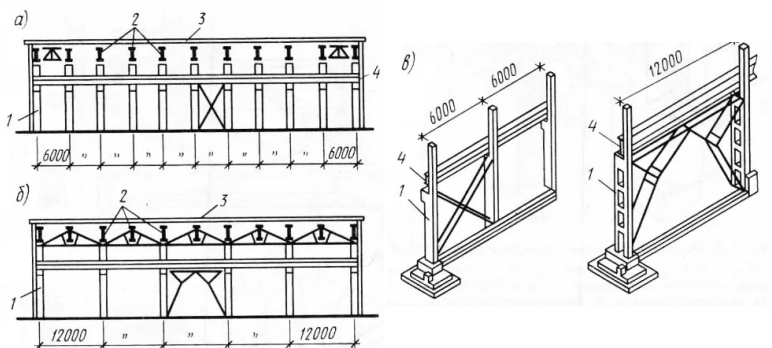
Вертикальные связи между железобетонными колоннами:
